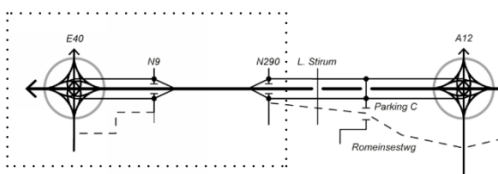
Alternative raisonnable 2 groupe 2 zone de Wemmel
